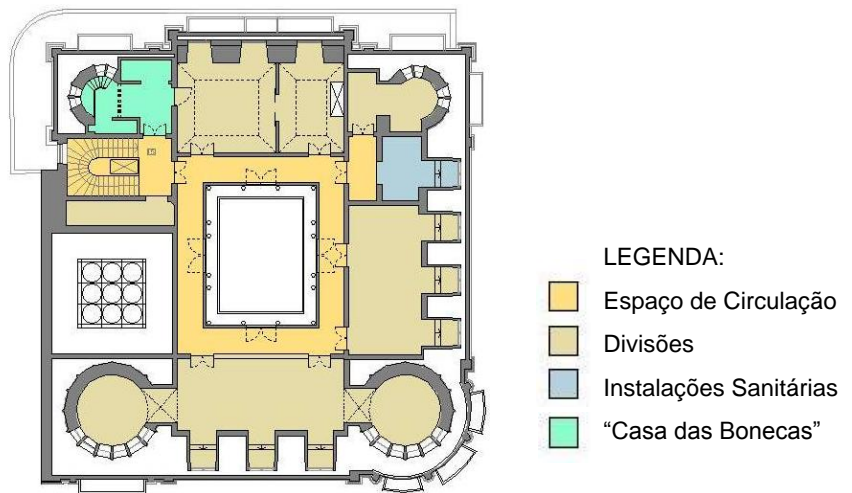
Palacete Ribeiro da Cunha-planta Piso 2
